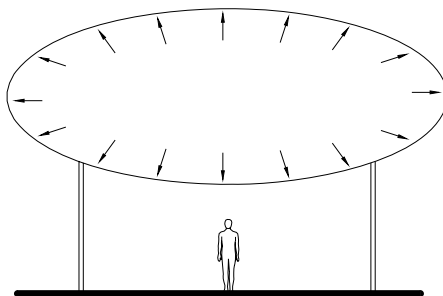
Esquema de estrutura pneumática do tipo Inflada. Fonte: Adaptado de PAULETTI (2003).
